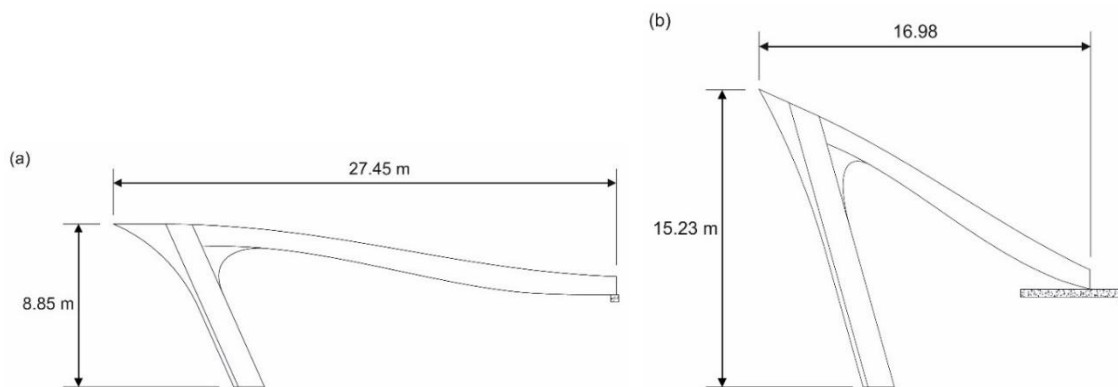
a) Pórtico 13, y b) pórtico 19 (Oak Ingeniería)
